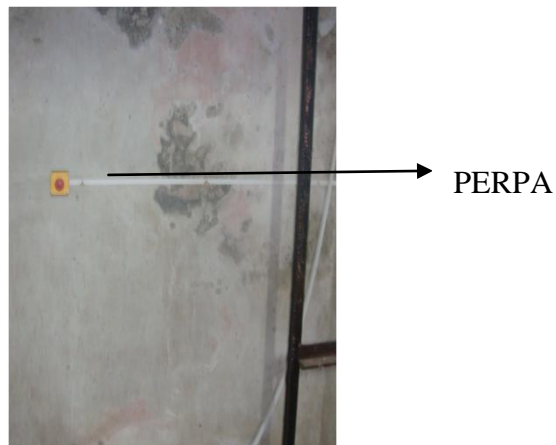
Pulsador de paro de emergencia instalado en el recinto planta alta
